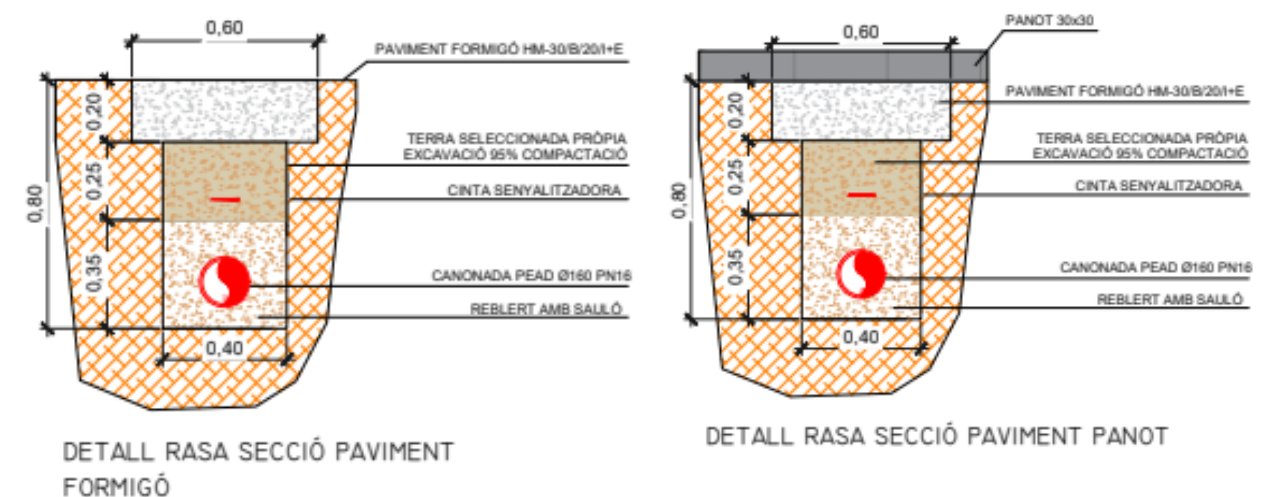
Detall rasa secció paviment de formigó en la zona del Casc Antic
